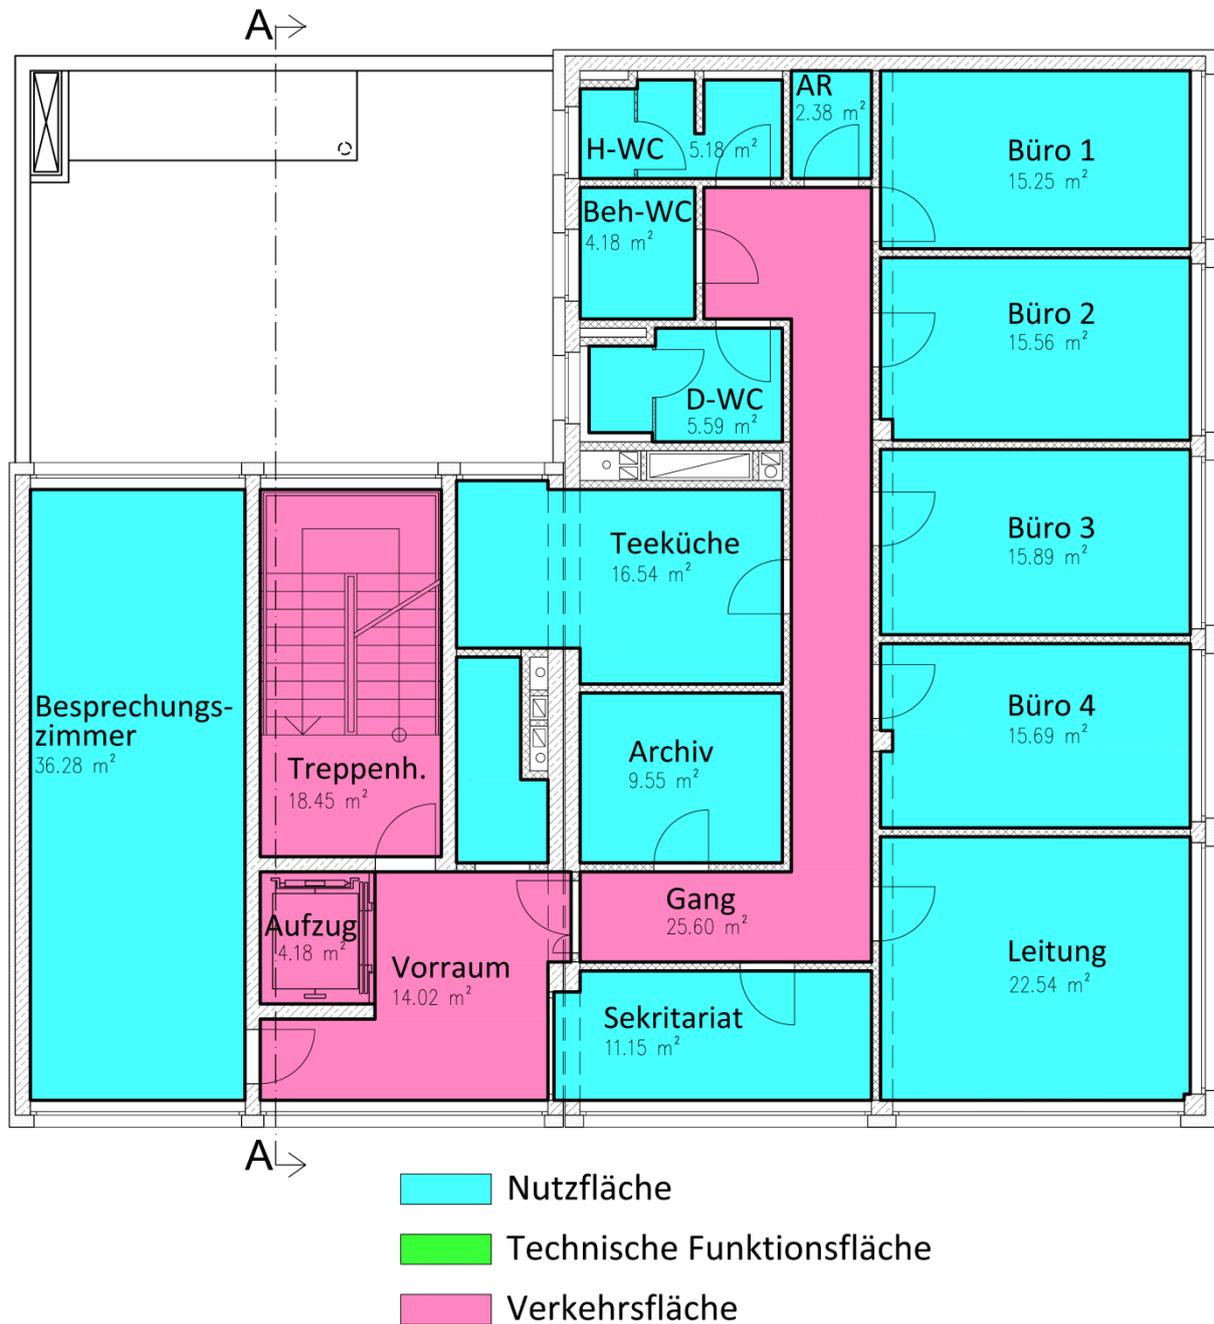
Flächenplan – Grundriss 1.OG bis 3.OG
